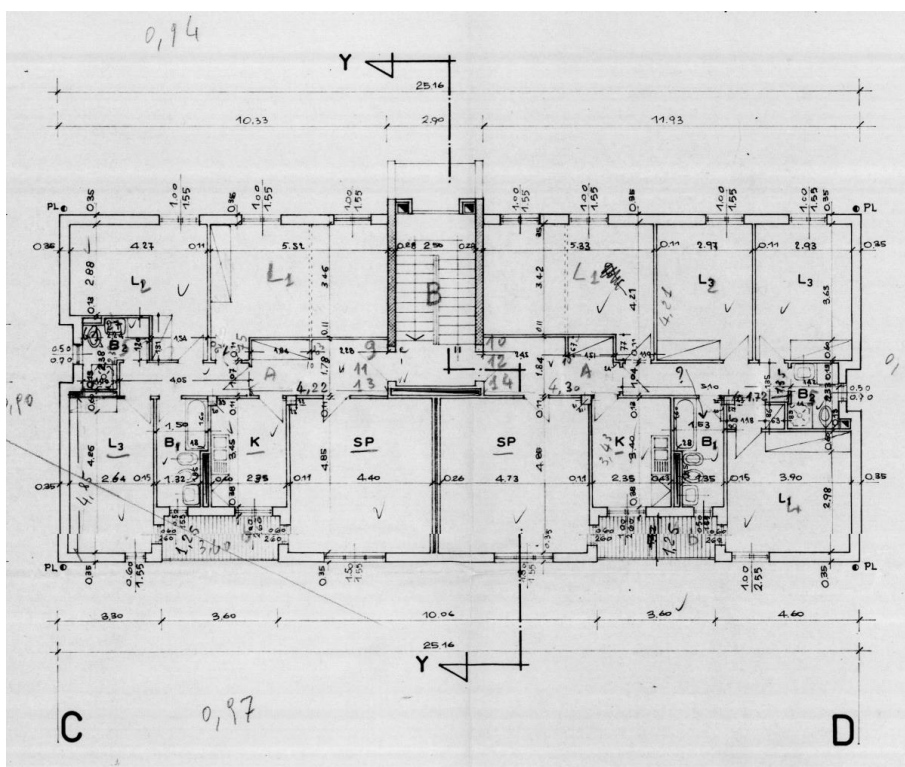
, Pianta Piano Tipo, scansione progetto originale
